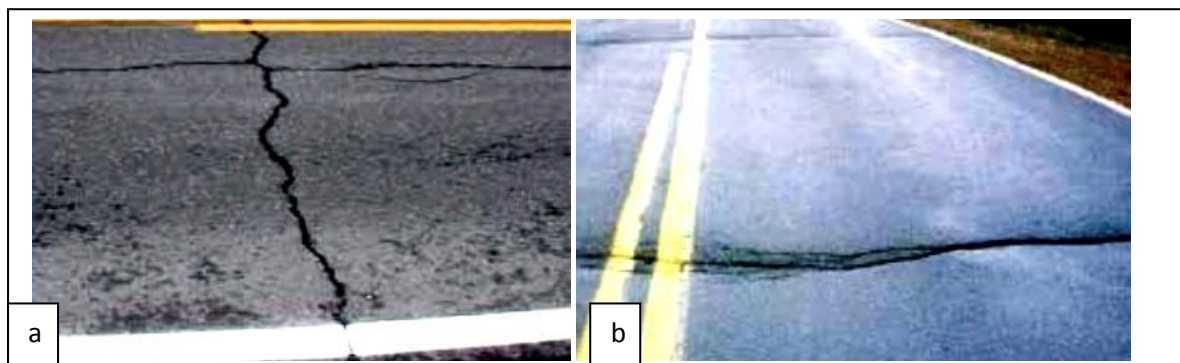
fissures transversales (a : moyen – b- majeur)
